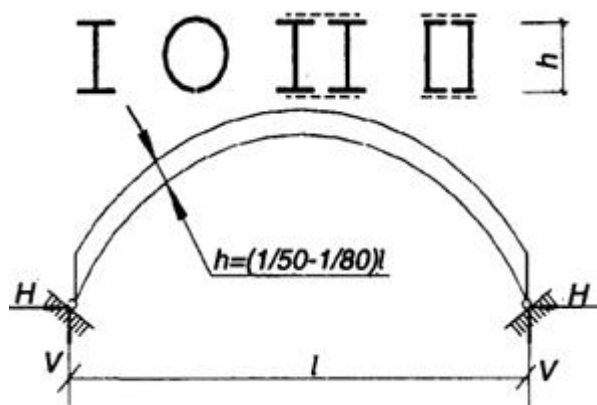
Конструктивная схема и типы сечений сплошной двухшарнирной арки
